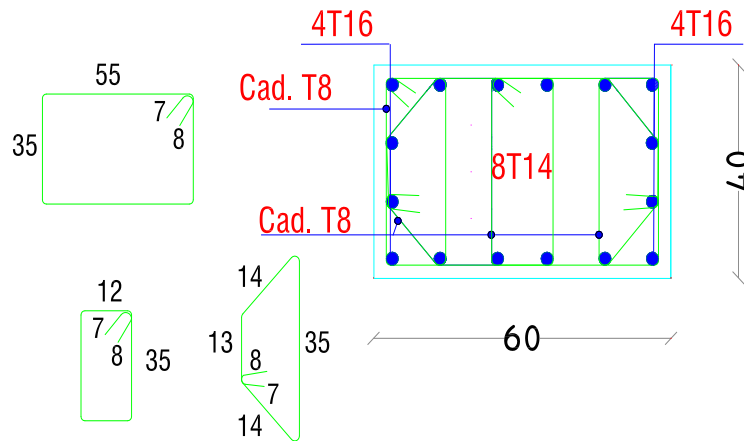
coupe Ferrailage des poteaux (60×40) cm<sup>2</sup>.
